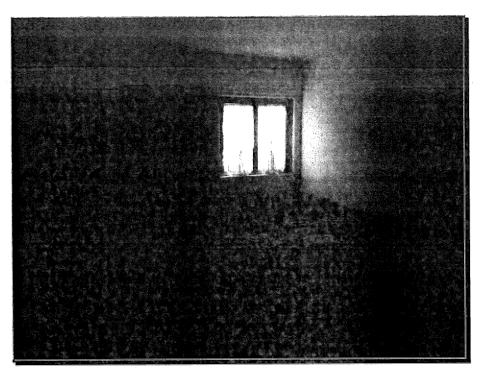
VISTA CUCINA APPARTAMENTO
